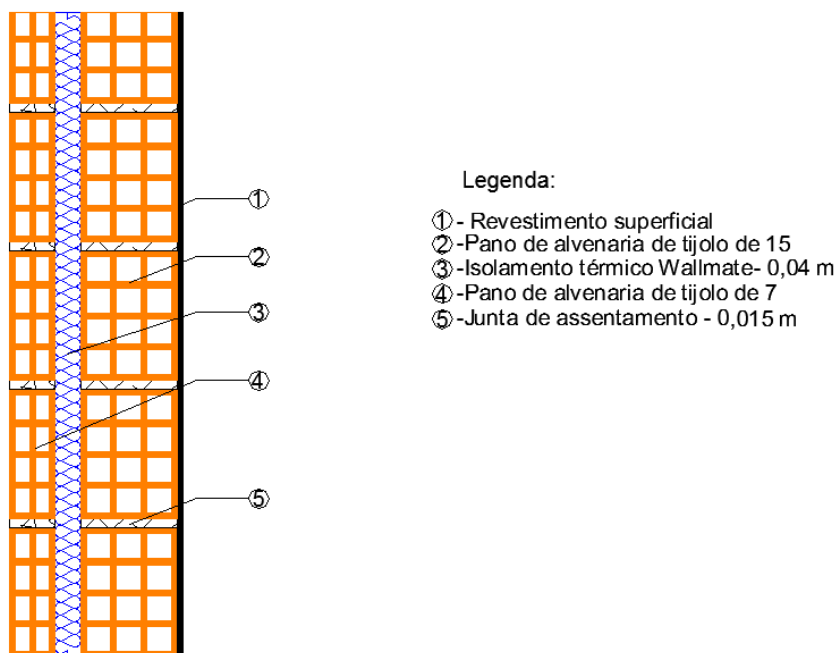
Pormenor construtivo da parede exterior dos pórticos 1-1’ e 2-2’
